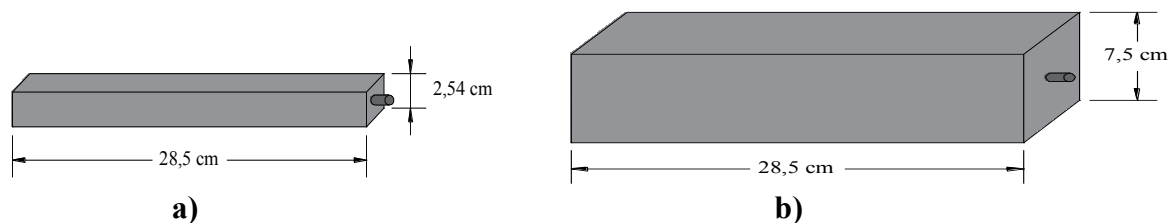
Probetas para cambios de longitud a) mortero y b) concreto.
